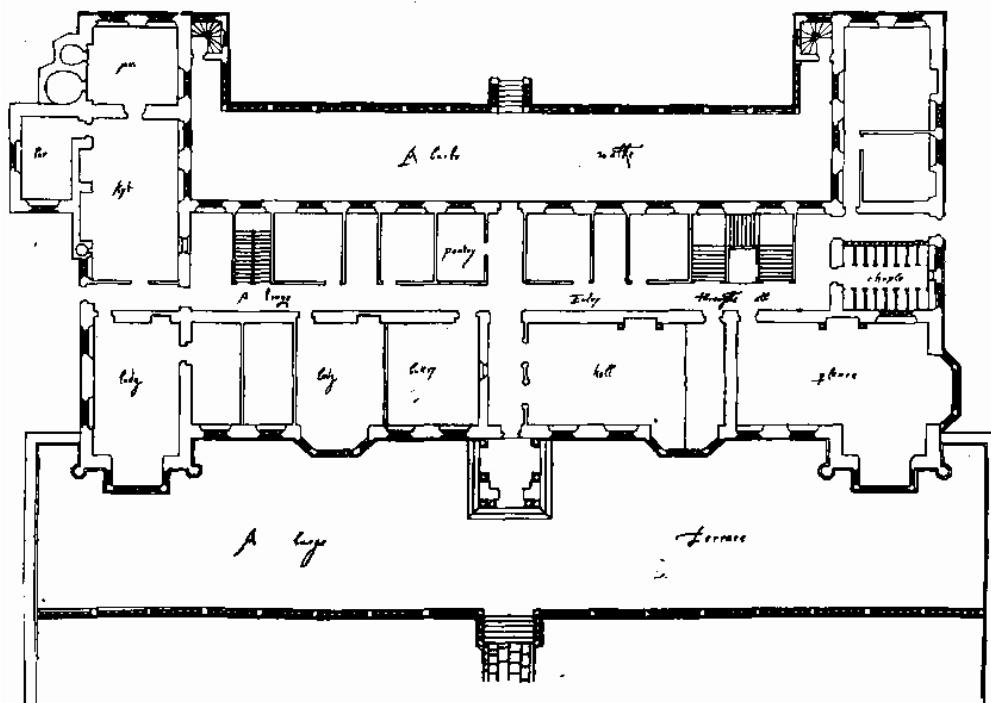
Planta de la Beaufort House, Chelsea. John Thorpe. 1597.
